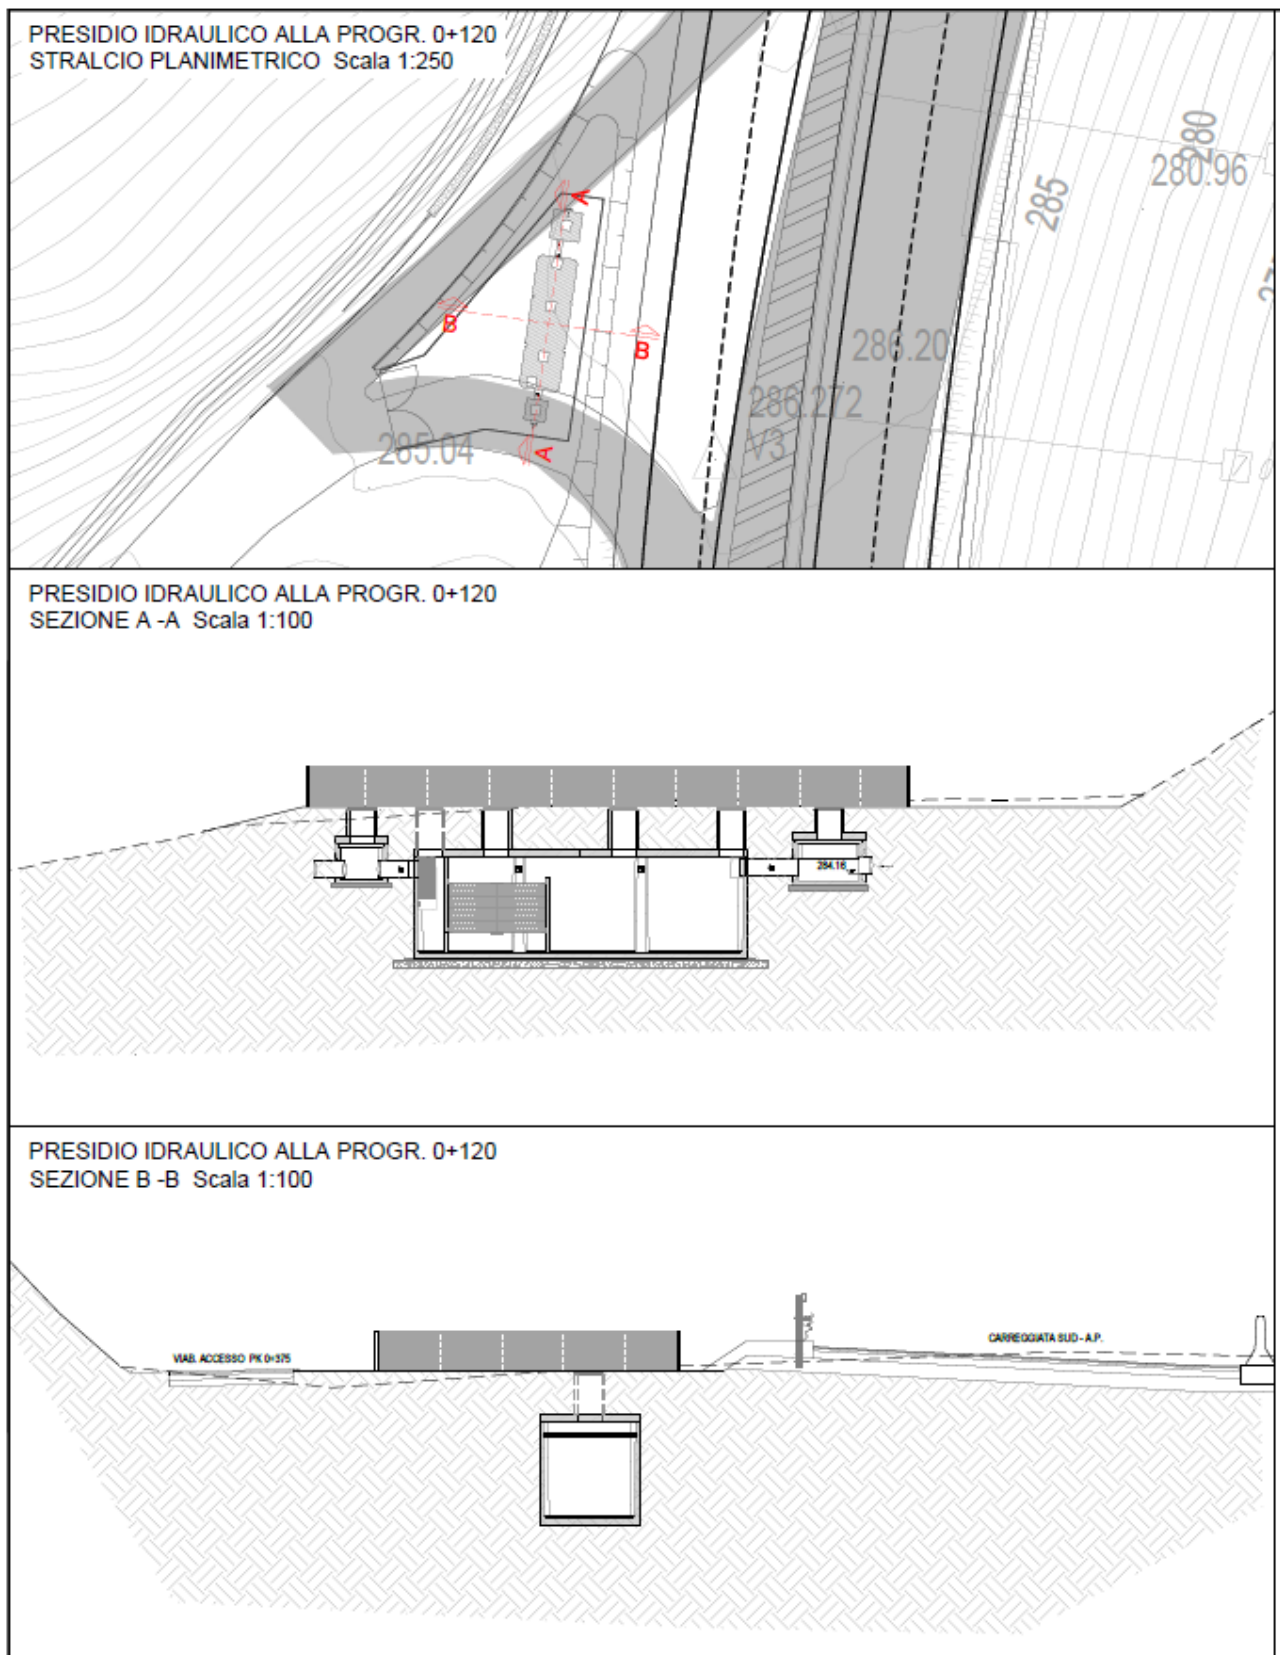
Stralcio planimetrico, profilo longitudinale e sezione TA01
